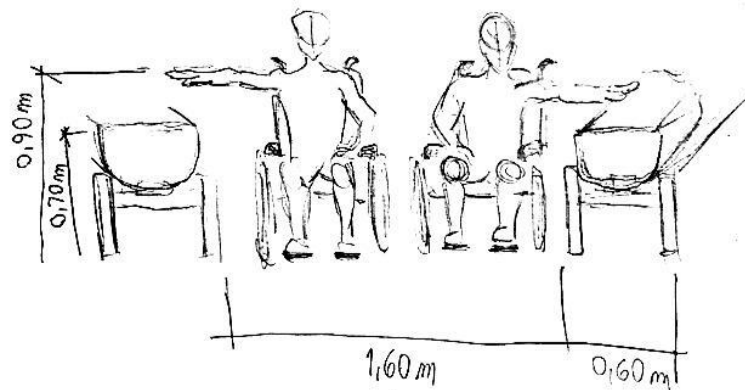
Demonstração dos Cadeiras ao Lado dos Canteiros.
